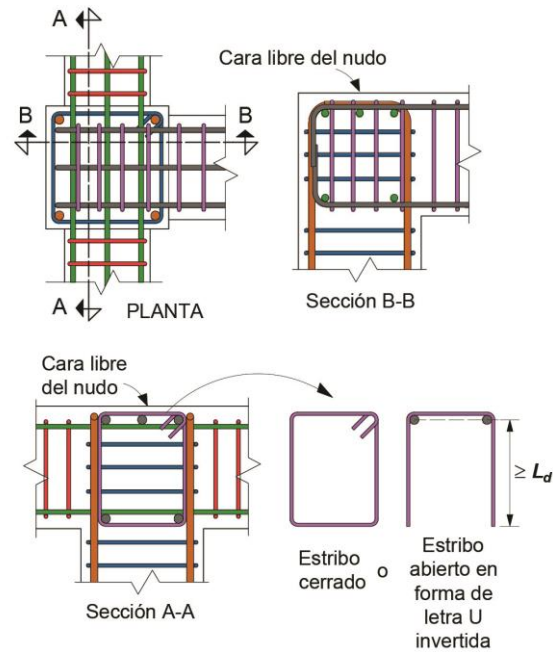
Refuerzo transversal vertical en uniones viga-columna de rodilla
